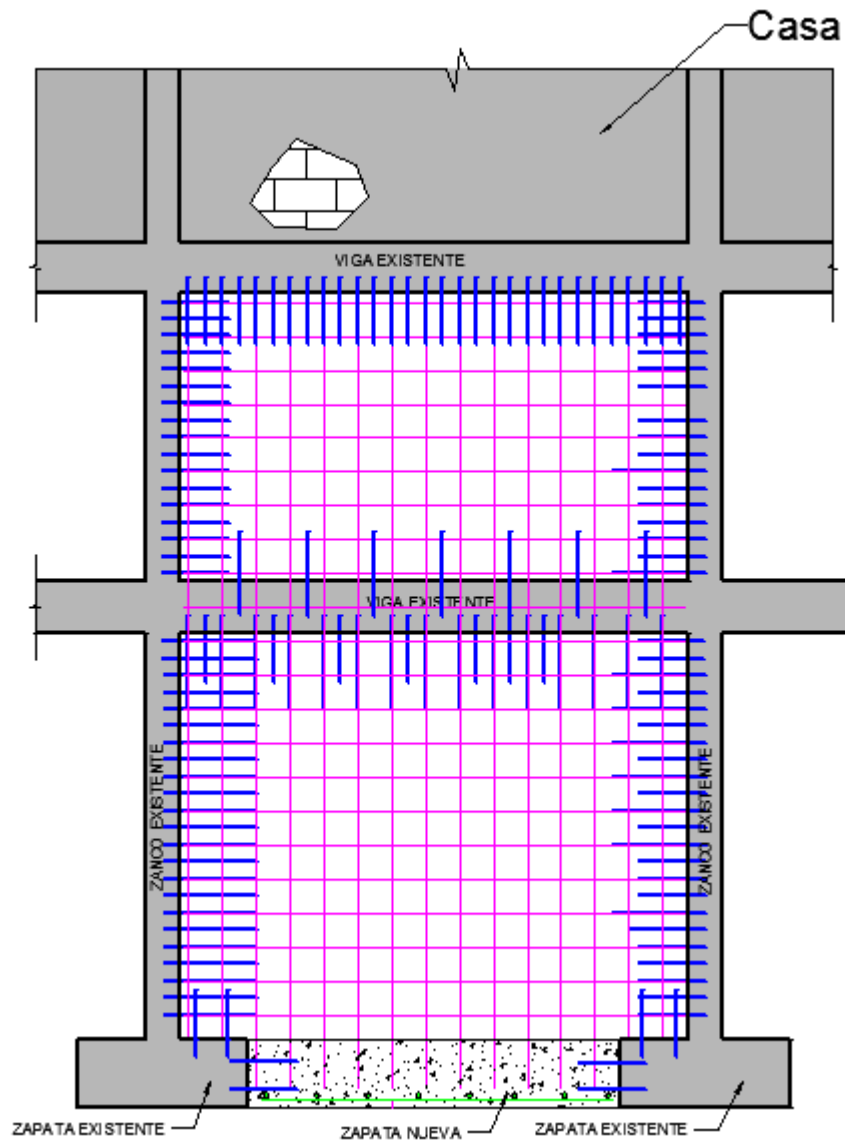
Instalación de Dowels y Refuerzo Vertical / Horizontal con una Viga a Media Altura
